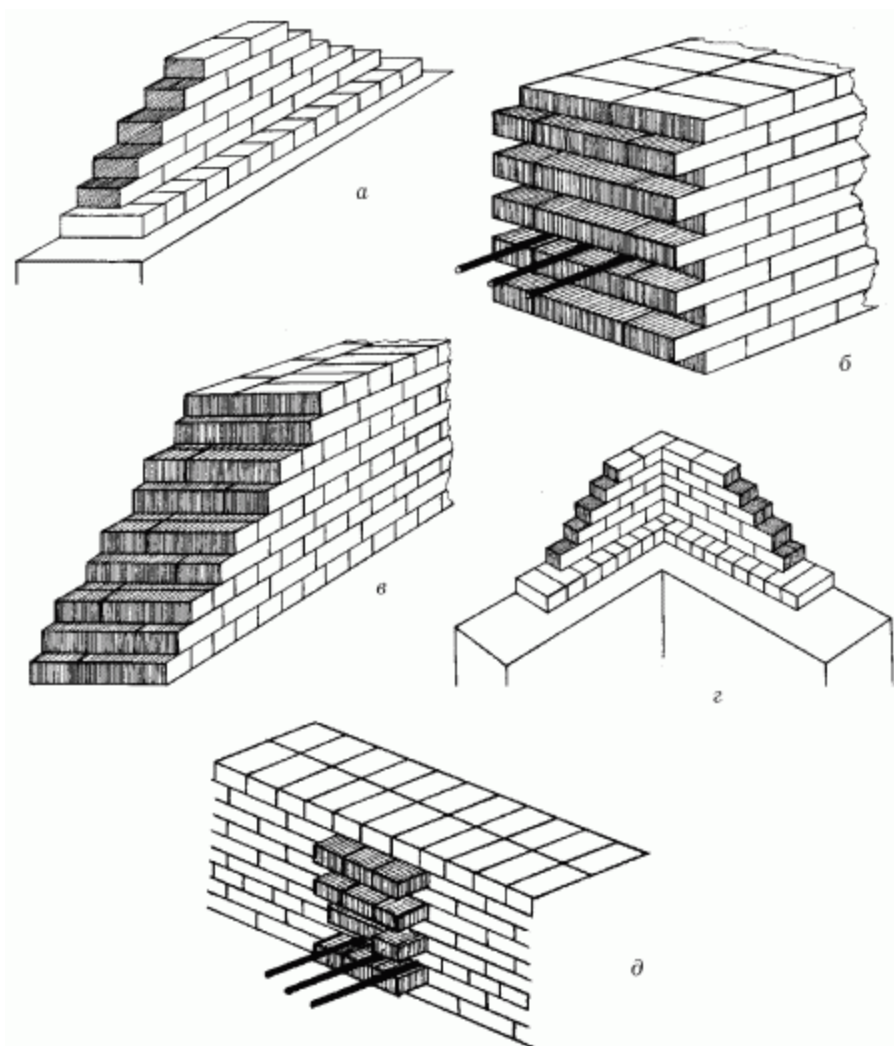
Штрабы: а – вертикальная на прямом участке; б – убежная; в – убежная промежуточная (маяк); г – вертикальная в месте примыкания другой стены; д – убежная угловая (маяк).
